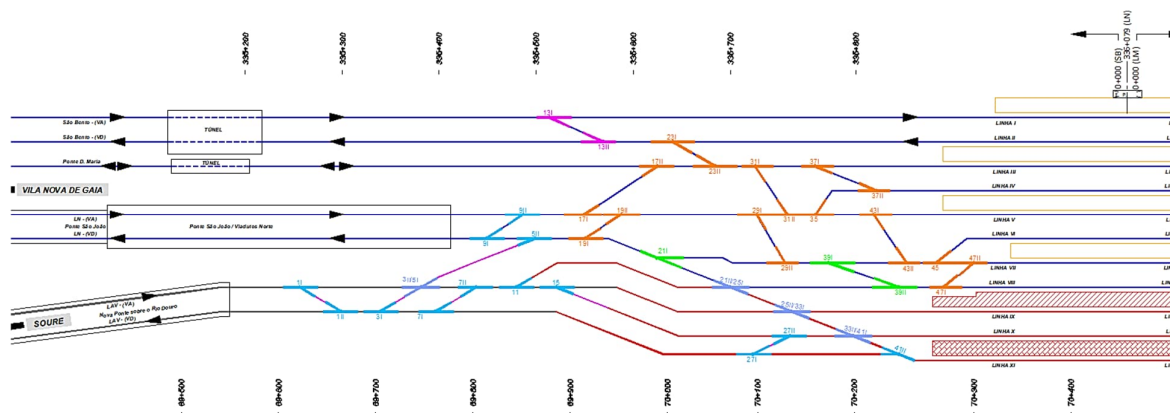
Estação de Campanhã – Situação Futura – Entrada – Lado Sul
